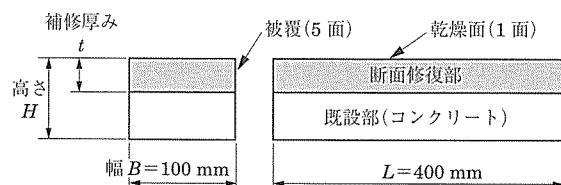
ひび割れ抵抗性試験に用いる供試体形状
